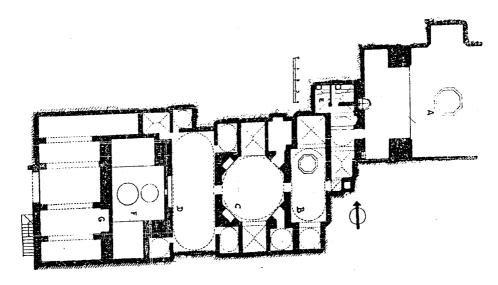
مسقط أفقي لقصر المشتي .(عن ، كريزول).
